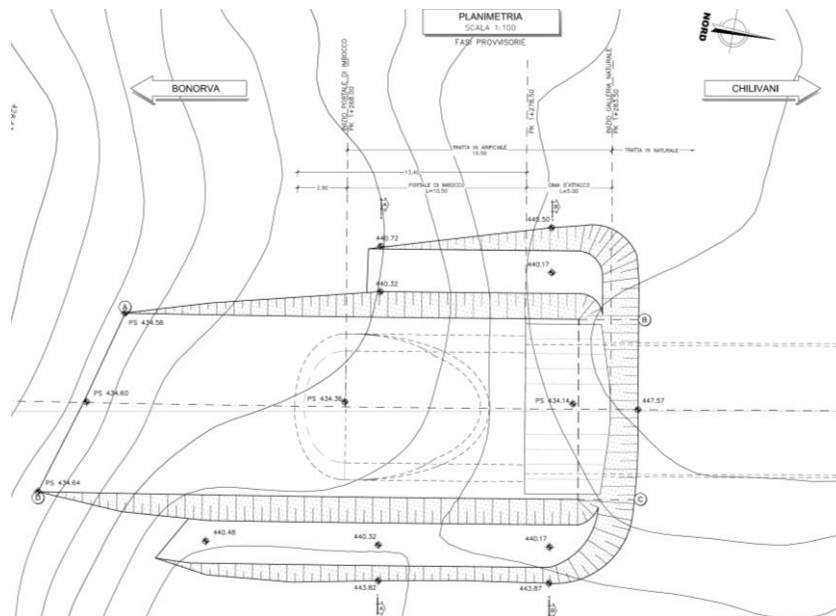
Galleria Monte Martis – Imbocco lato Bonorva – Planimetria in fase provvisoria
